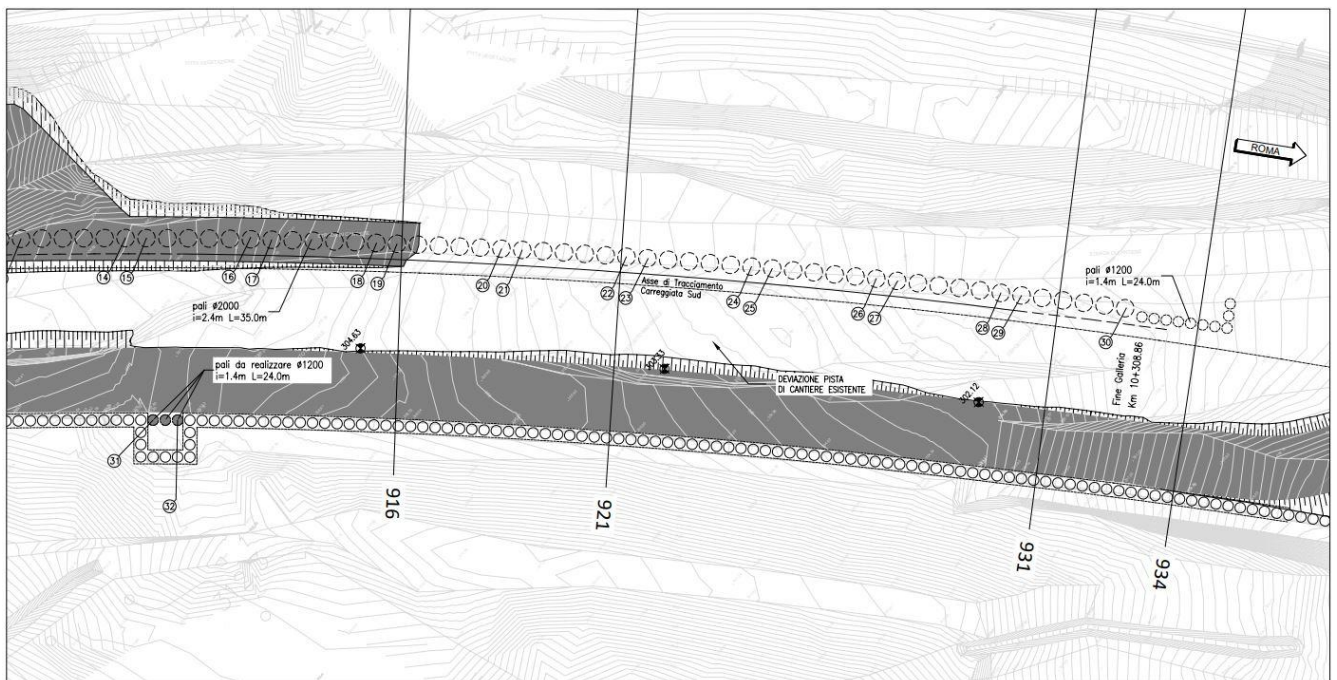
Planimetria area intervento fase 1 (1 di 2)
